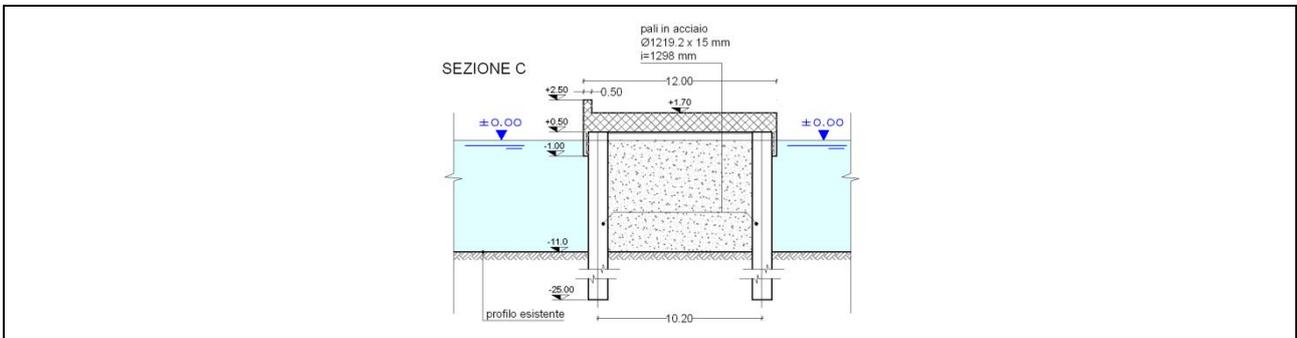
Sezione tipica della testata del pennello (sezione C-C)
